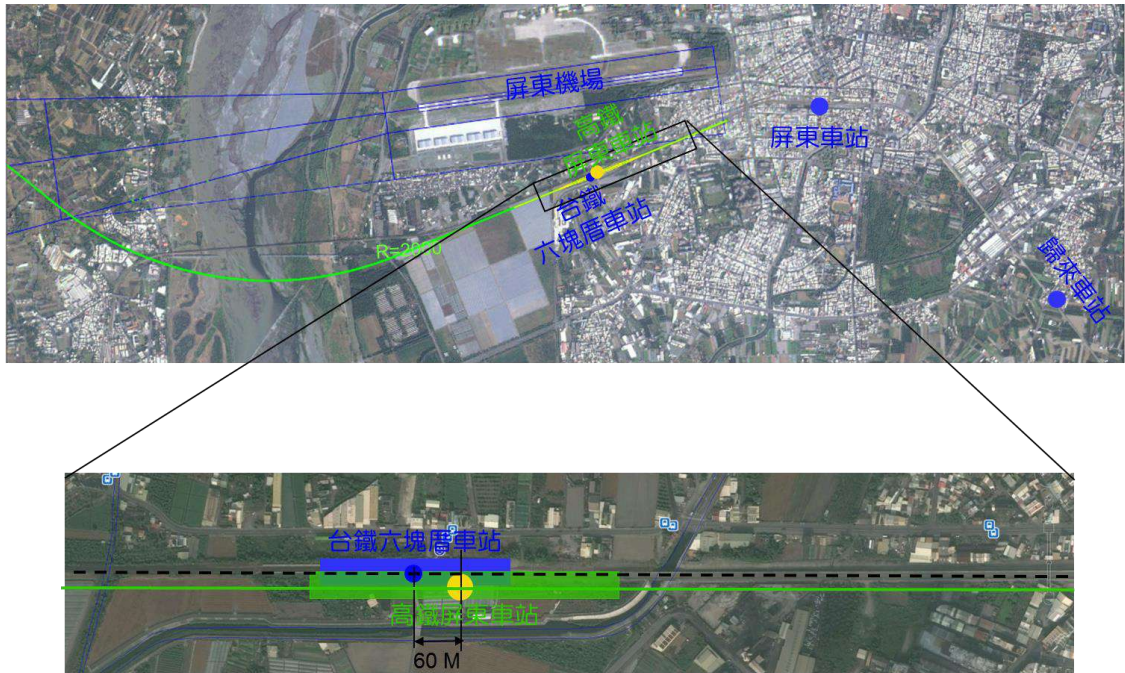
與臺鐵六塊厝車站南邊共站平面圖
